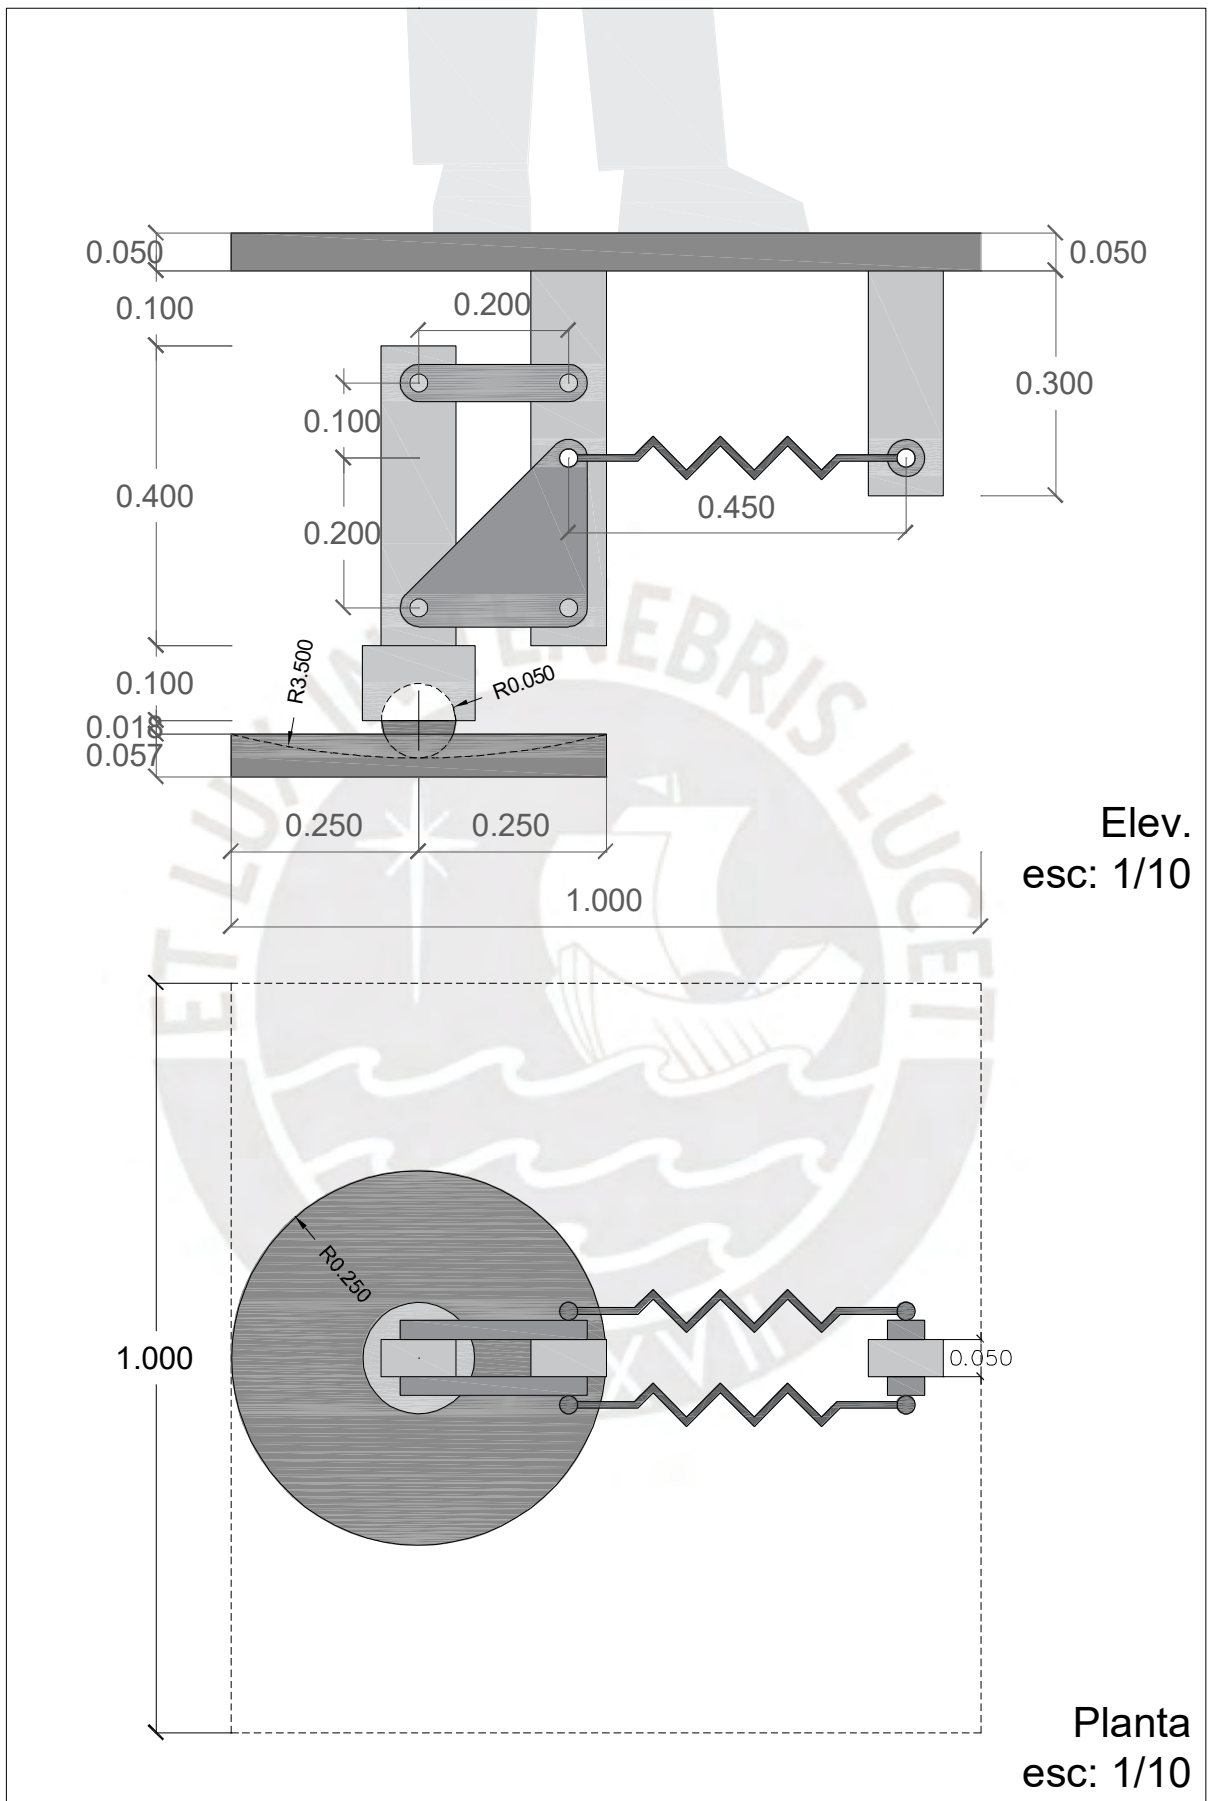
16: Elevación y planta del primer modelo de sistema de aislamiento.
